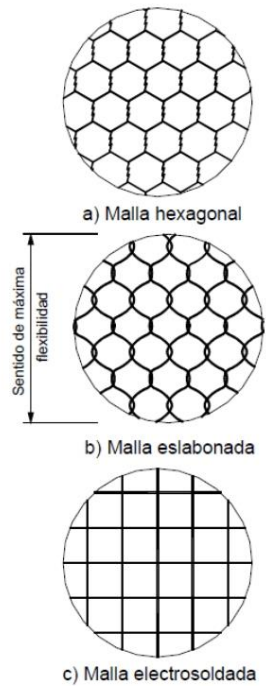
Tipos de mallas utilizadas en la construcción de gaviones. Fuente: (Suárez Díaz, 2001).
